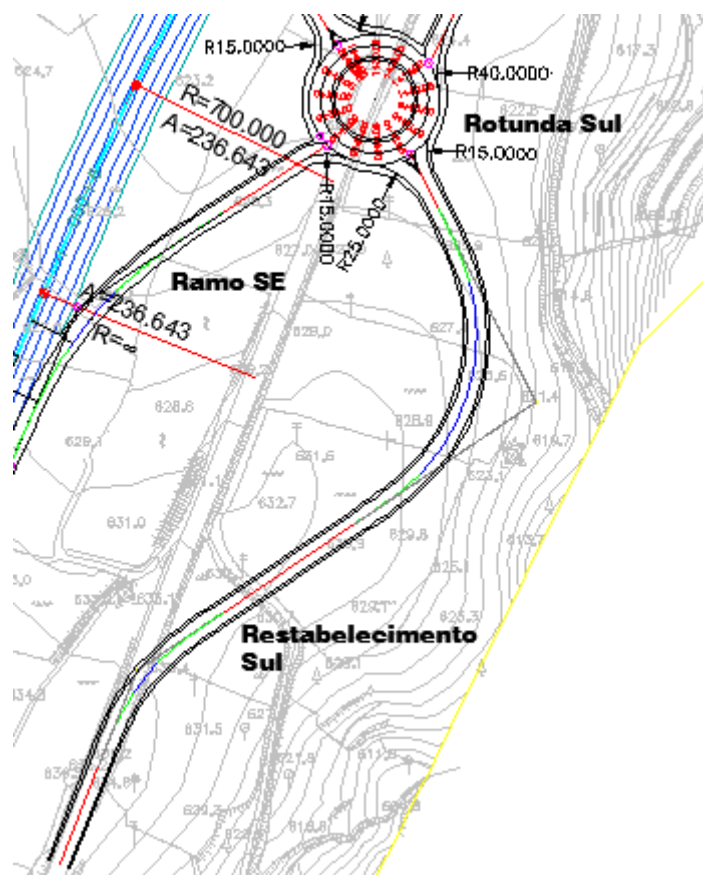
Pormenor da Planta do Restabelecimento Sul
